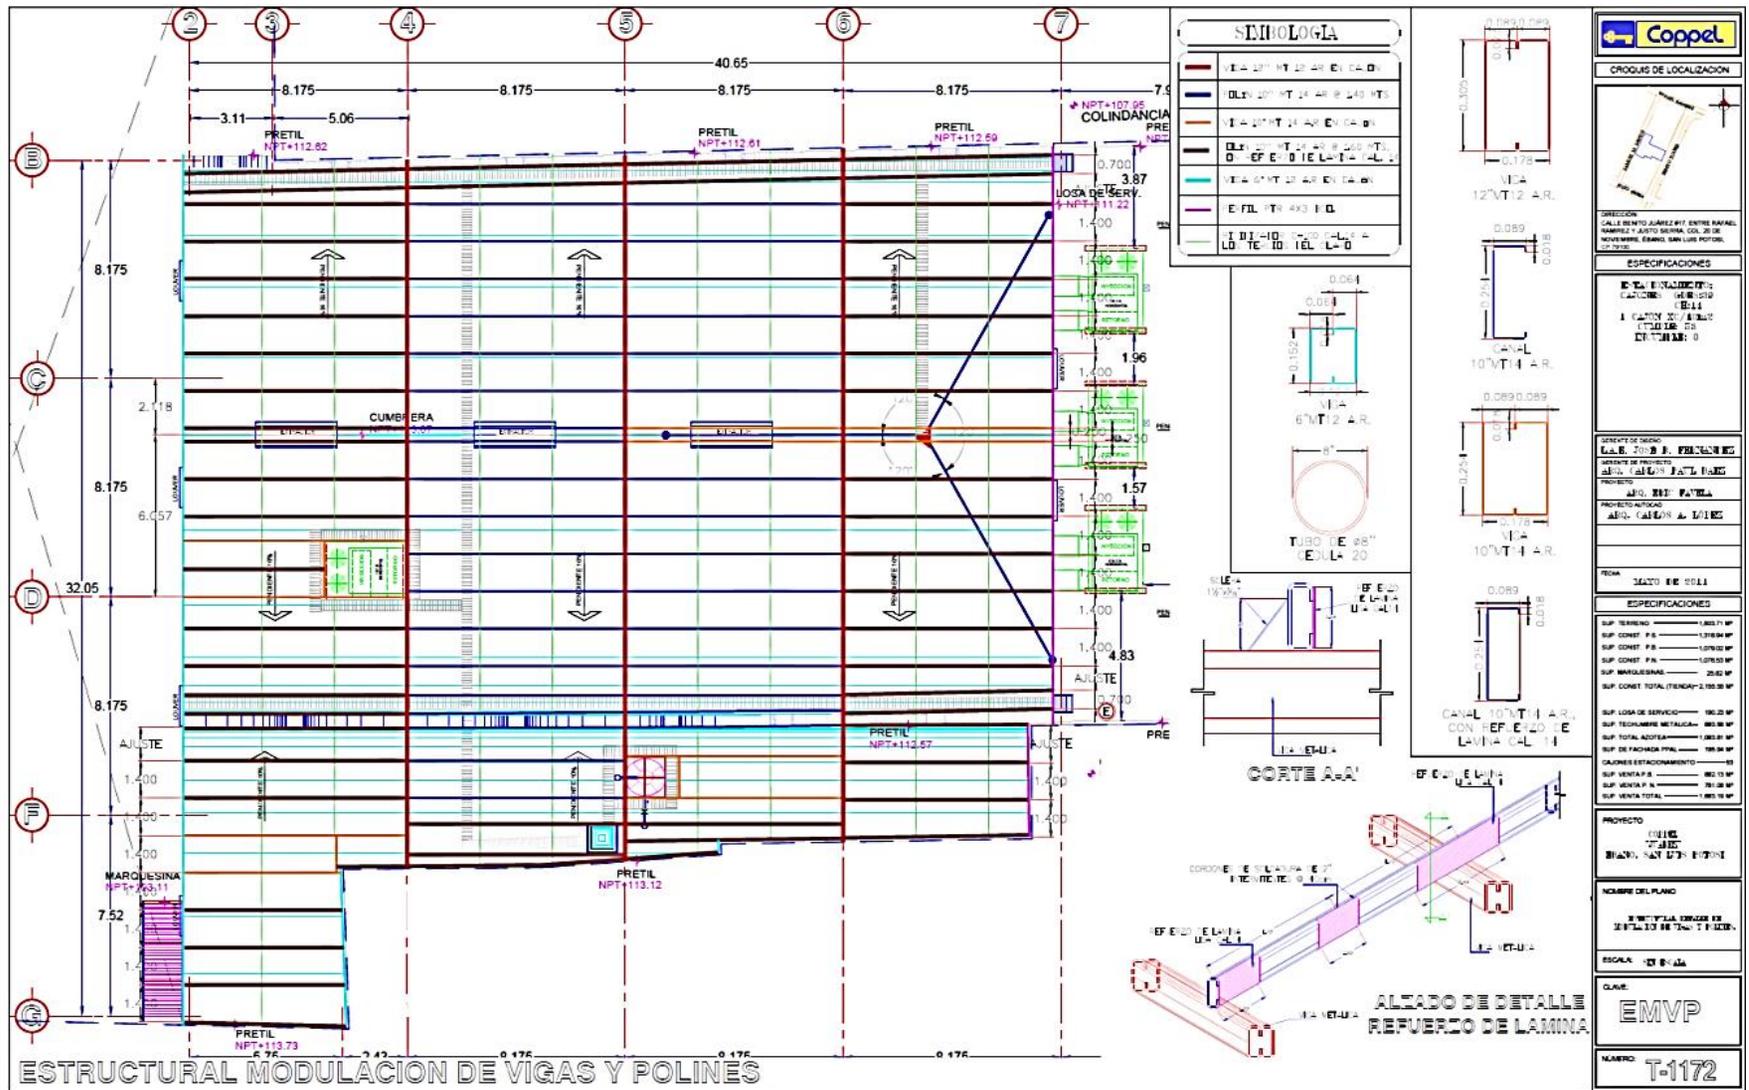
Plano estructural de modulación de vigas y polines en techumbre metálica.
